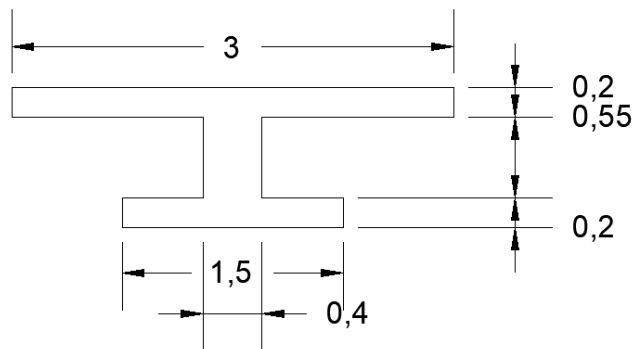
Sección transversal de la pasarela, acotada en metros, para SAP2000. Fuente: Propia con AutoCAD.
